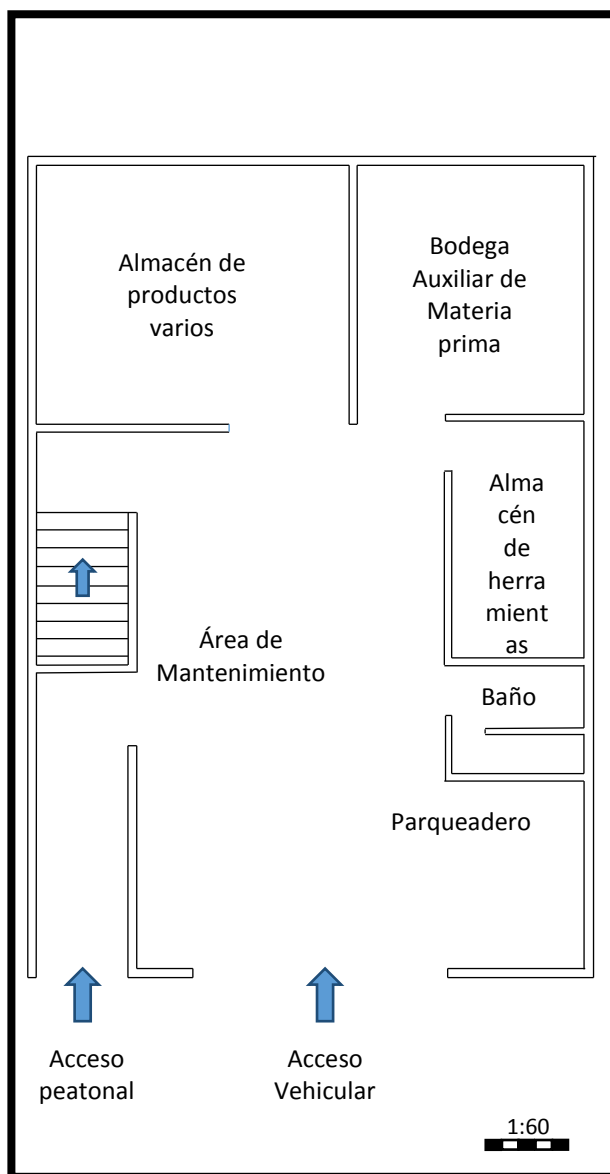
Piso 1, Distribución en planta. Nota: Autoría propia
